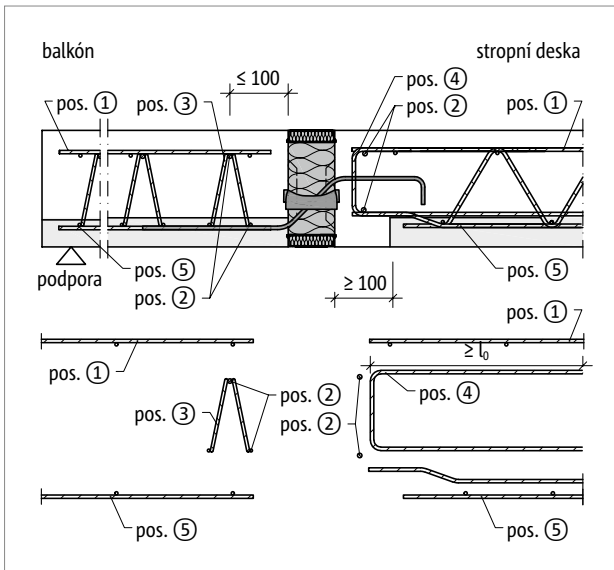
Schöck Isokorb® T typ QLN-V9 až V10: Napojovací stavební výztuž
